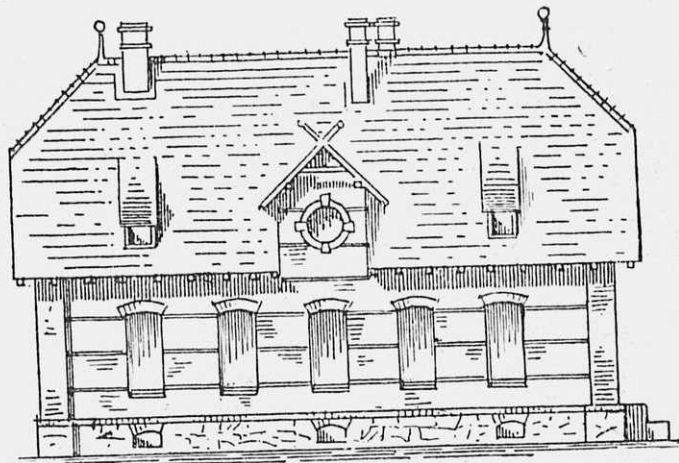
Хозяйскій домъ на среднемъ хуторѣ (изъ камня, бетона и самана). Фасадъ.
